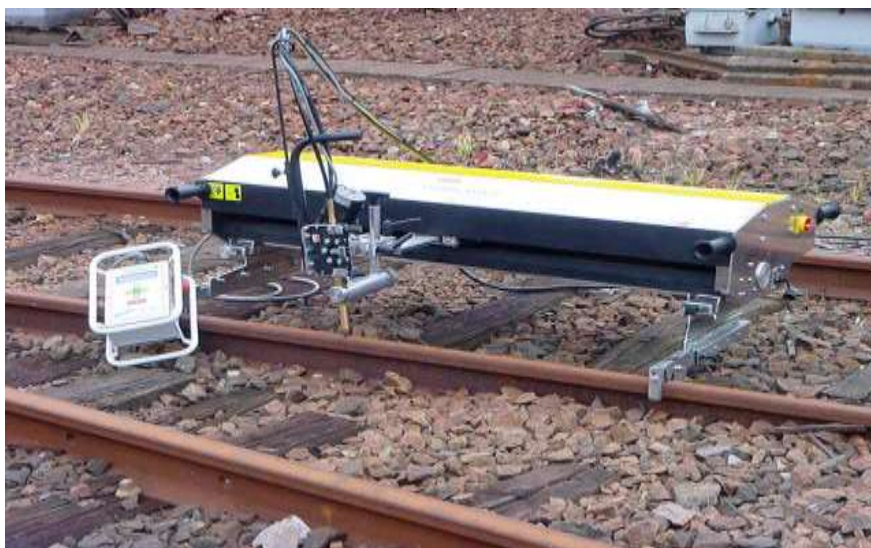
Трансламатик вариант установки для наплавки рельсовых концов
